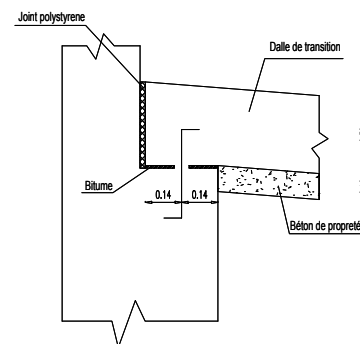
DETAIL DU JOINT DE CHAUSSEE (Type D80)
